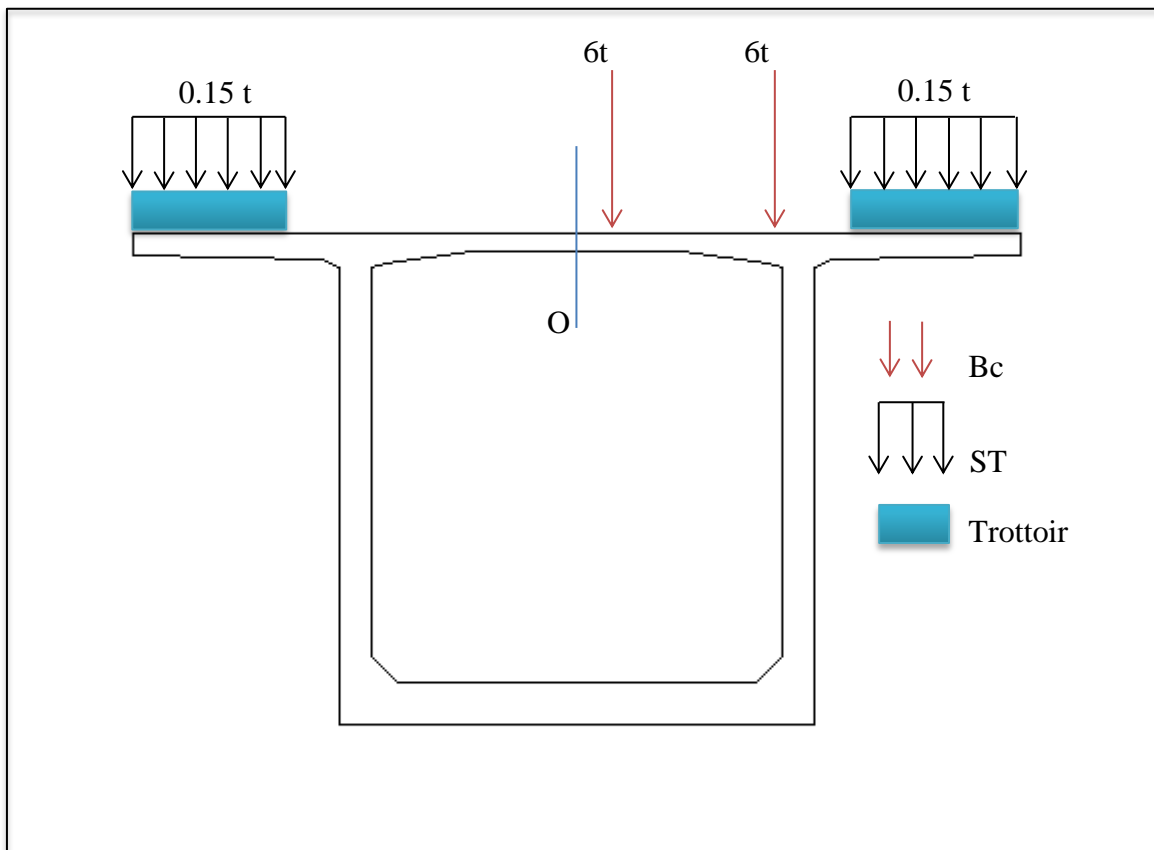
Coupe transversale du voussoir sur pile chargé en dehors de son plan de symétrie.
